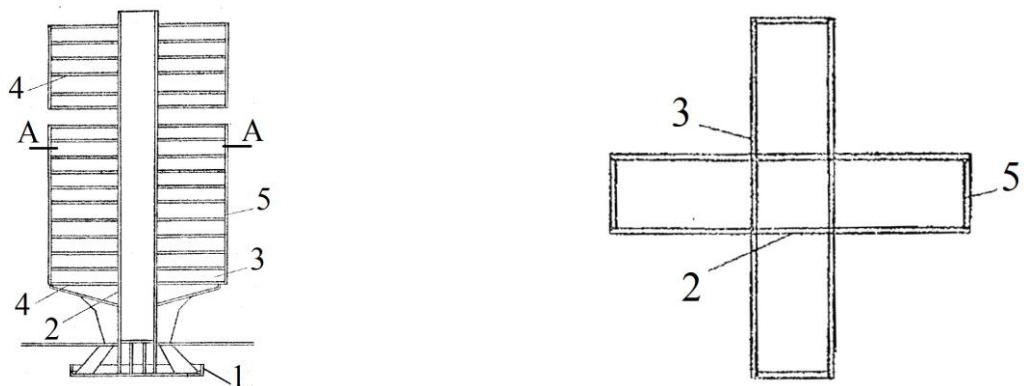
Многоэтажное здание: 1 – фундамент; 2 – железобетонная шахта; 3 – стеновые панели; 4 – панели перекрытия; 5 – наружные стеновые панели
